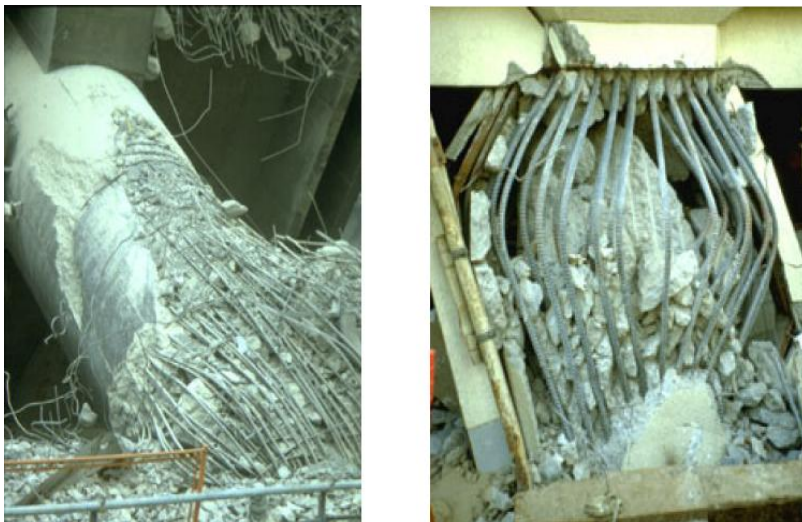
Ruine de piles de pont en béton armé "Kobe en 1995" [5]
